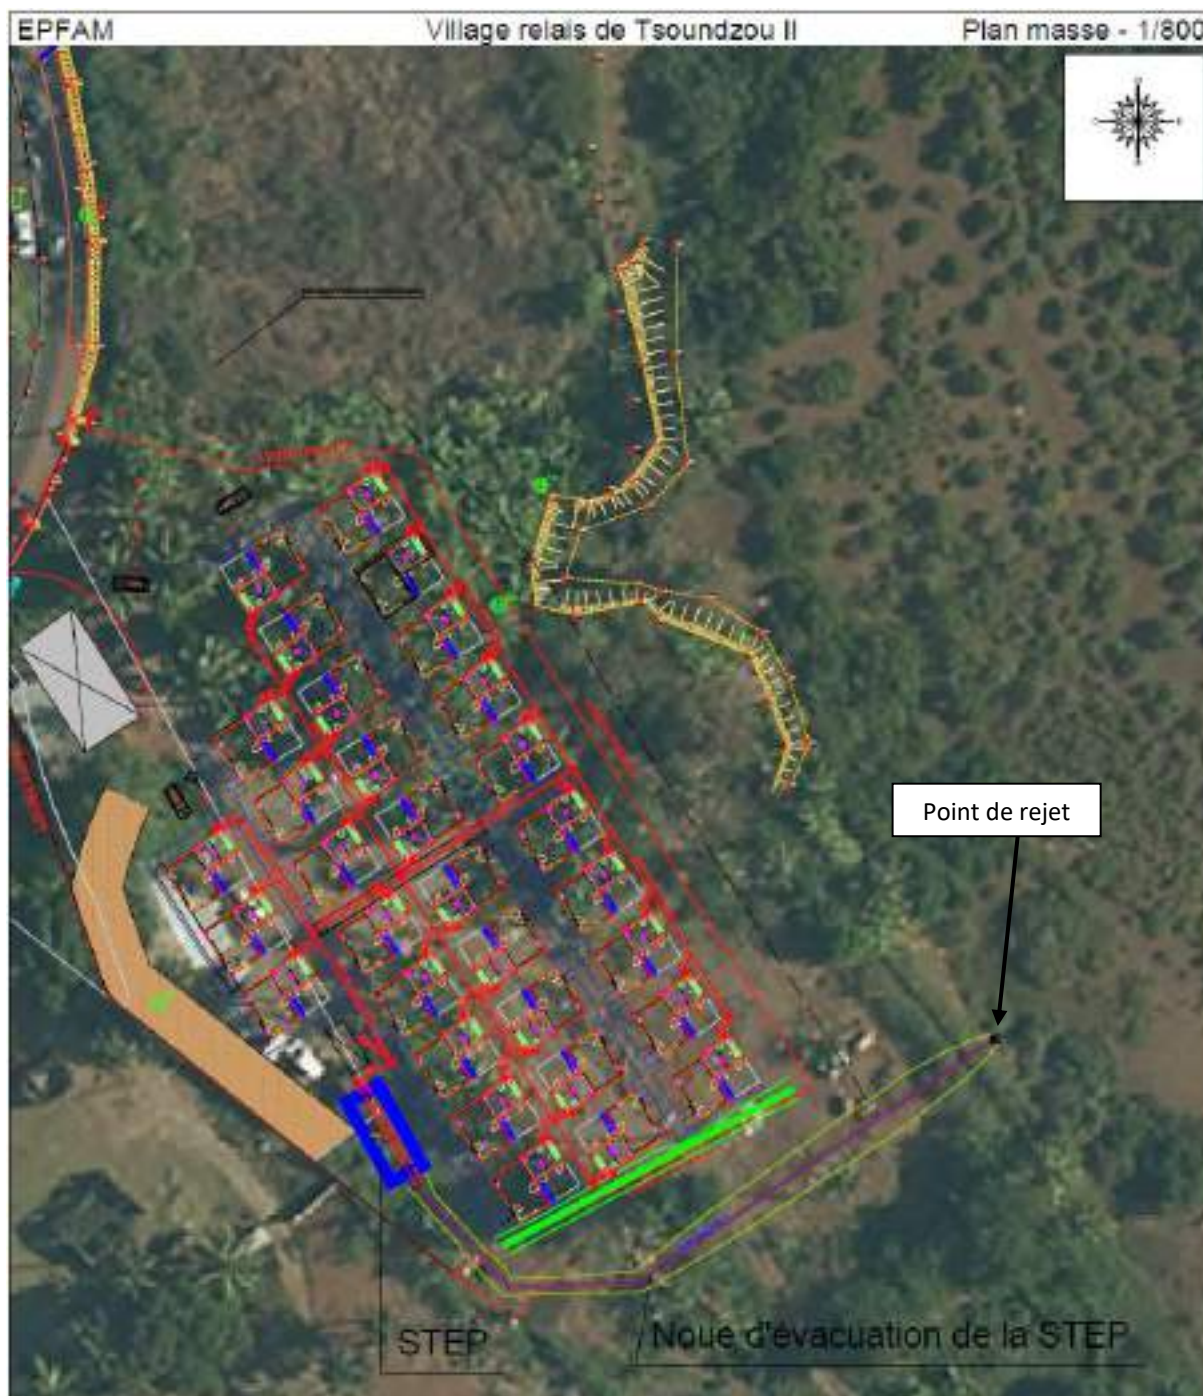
Plan du système de collecte des eaux usées (Source : ETG 2020)
